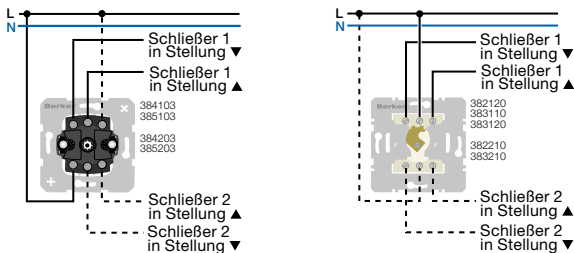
Jalousie-Drehschalter 1- und 2-polig [Best.-Nr. 3841 03, 3842 03]; Jalousie-Schalter 1- und 2-polig für Zentralstück mit Schloss [Best.-Nr. 3851 03, 3852 03] / Jalousie-Schalter/-Taster 1- und 2-polig für Schließzylinder [Best.-Nr. 382..., 383..]
